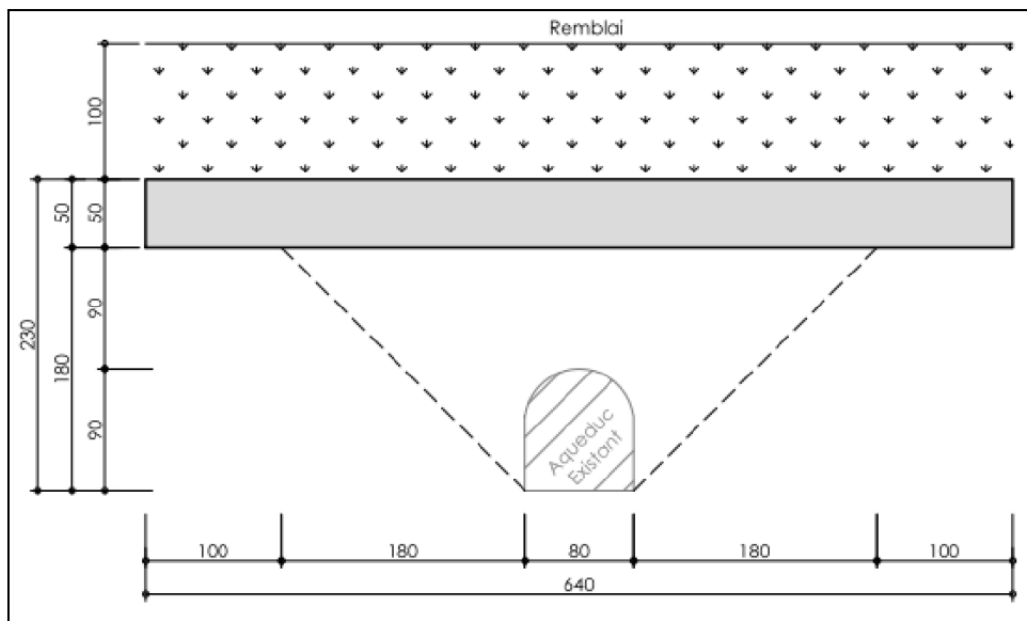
Schéma de la dalle béton mise en place pour la mise en protection de l'aqueduc (Source : Sodeba Ginko)
